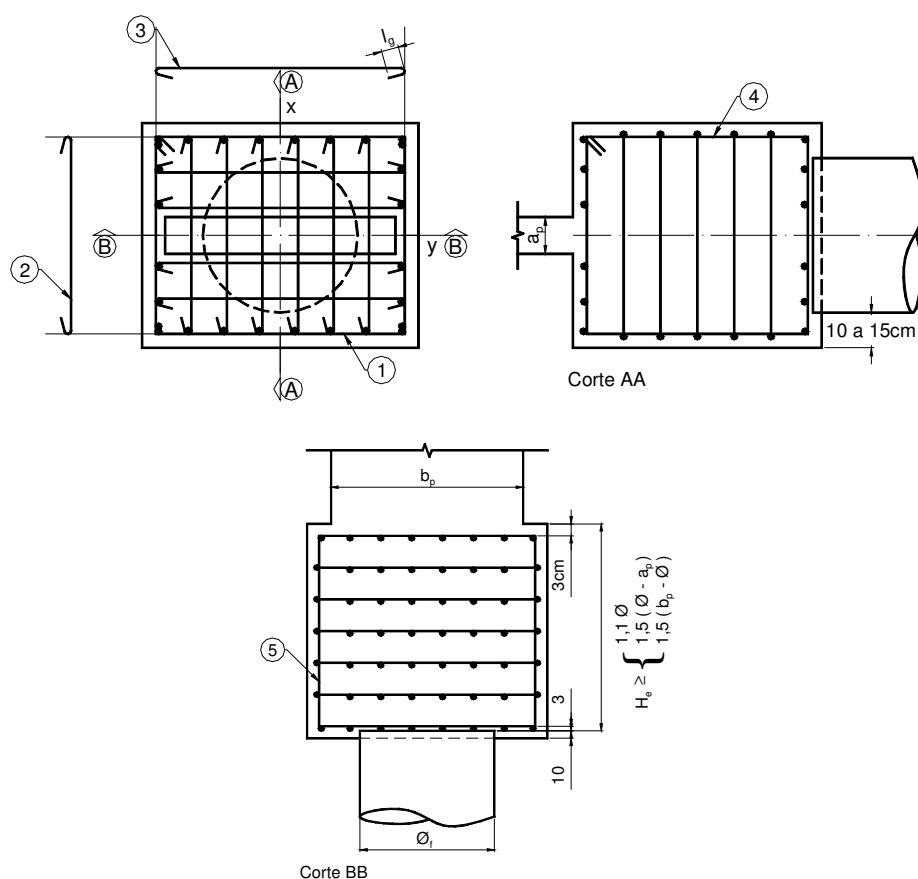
Exemplo de detalhamento das armaduras para o bloco de transição.
